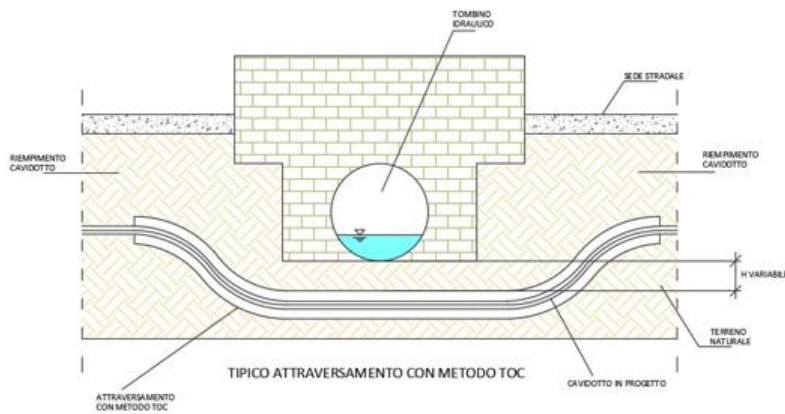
Sezione tipo di attraversamento mediante TOC
